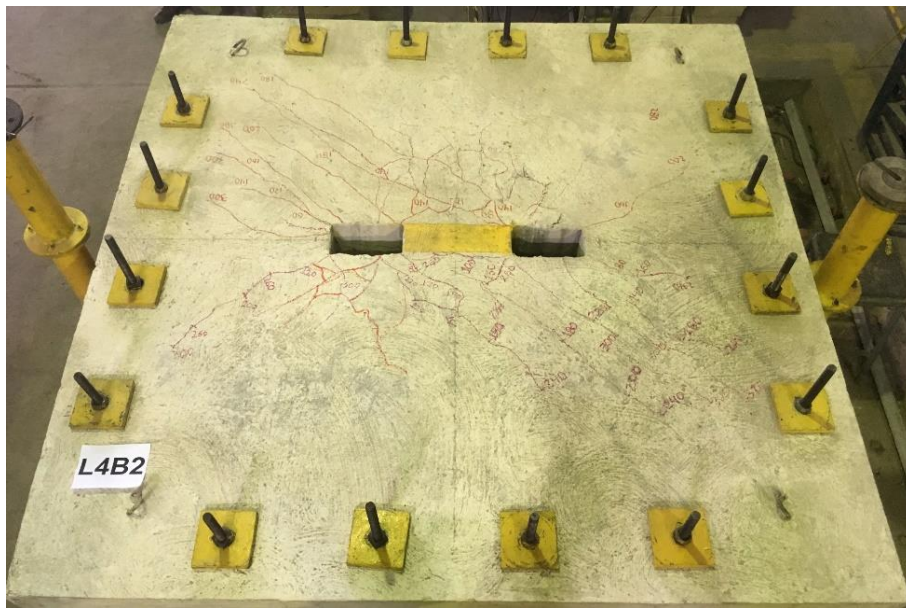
Padrão de fissuração da laje L4B2
